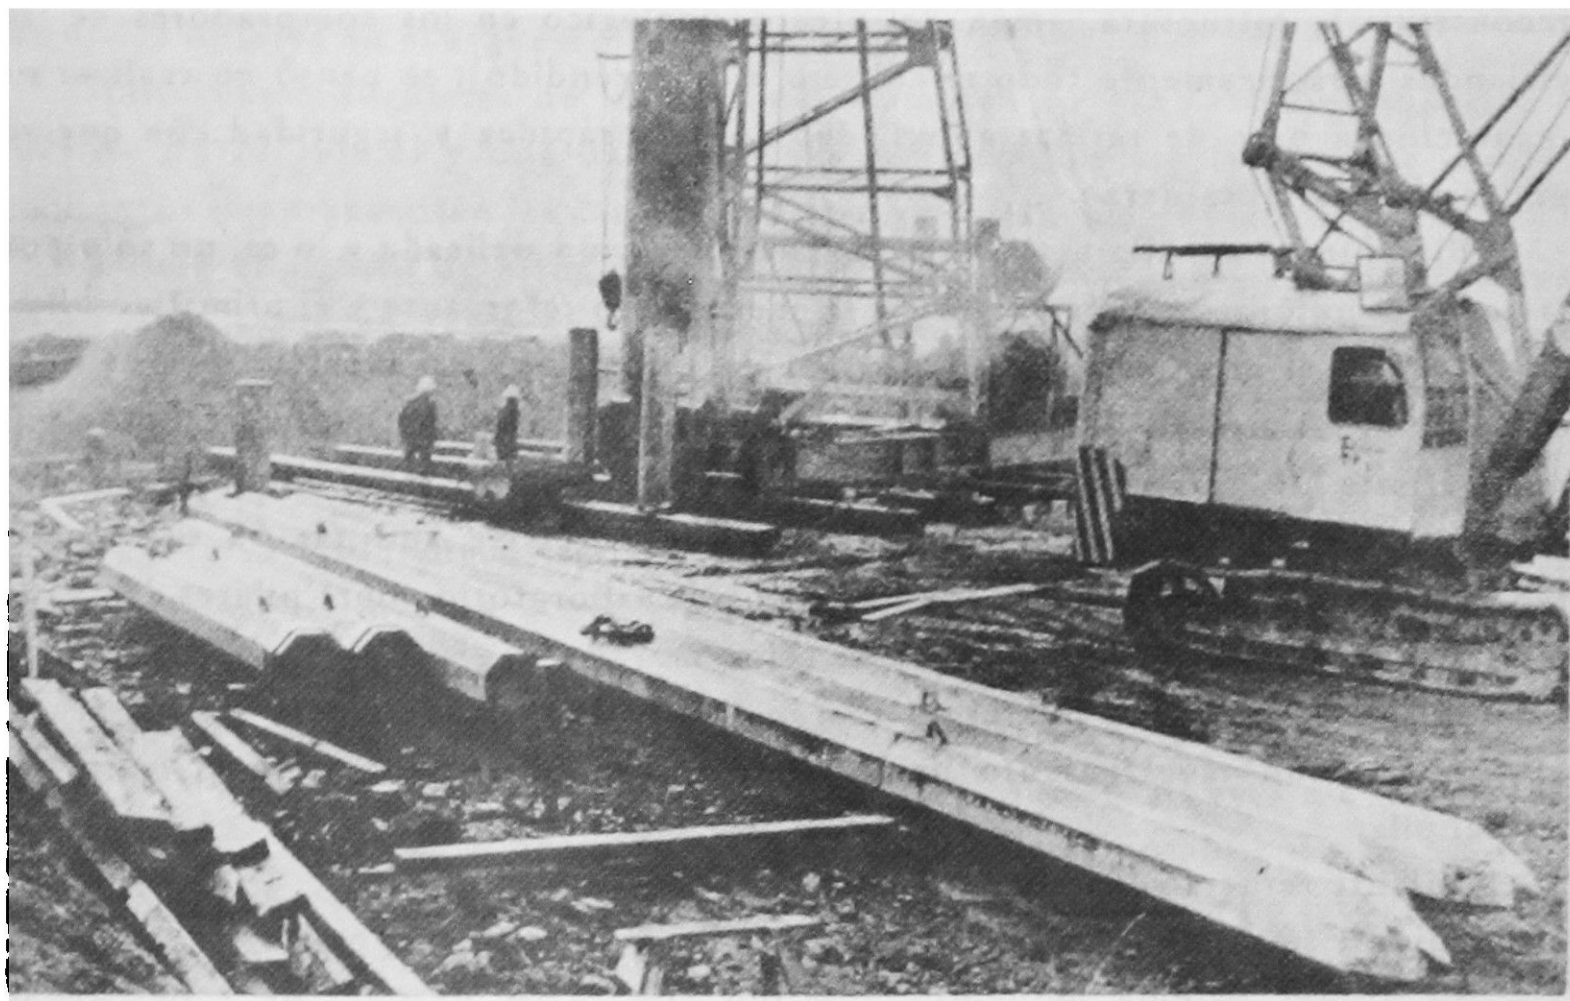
Conjunto de pilotes de hormigón armado fabricados en varios tramos unidos entre sí por medio de resinas epoxi.
